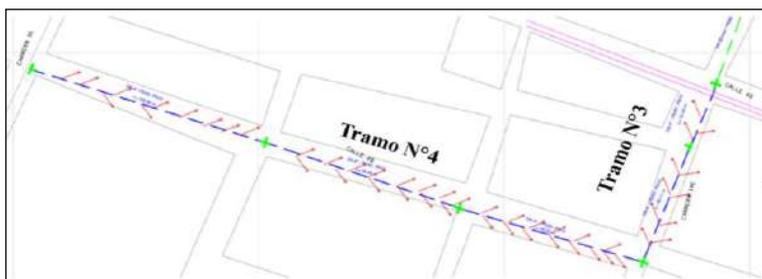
Plano de instalación de red de acueducto (Calle 4B entre Cra 16 y 14E) (Cra 14E entre Calles 4B y 4D).
